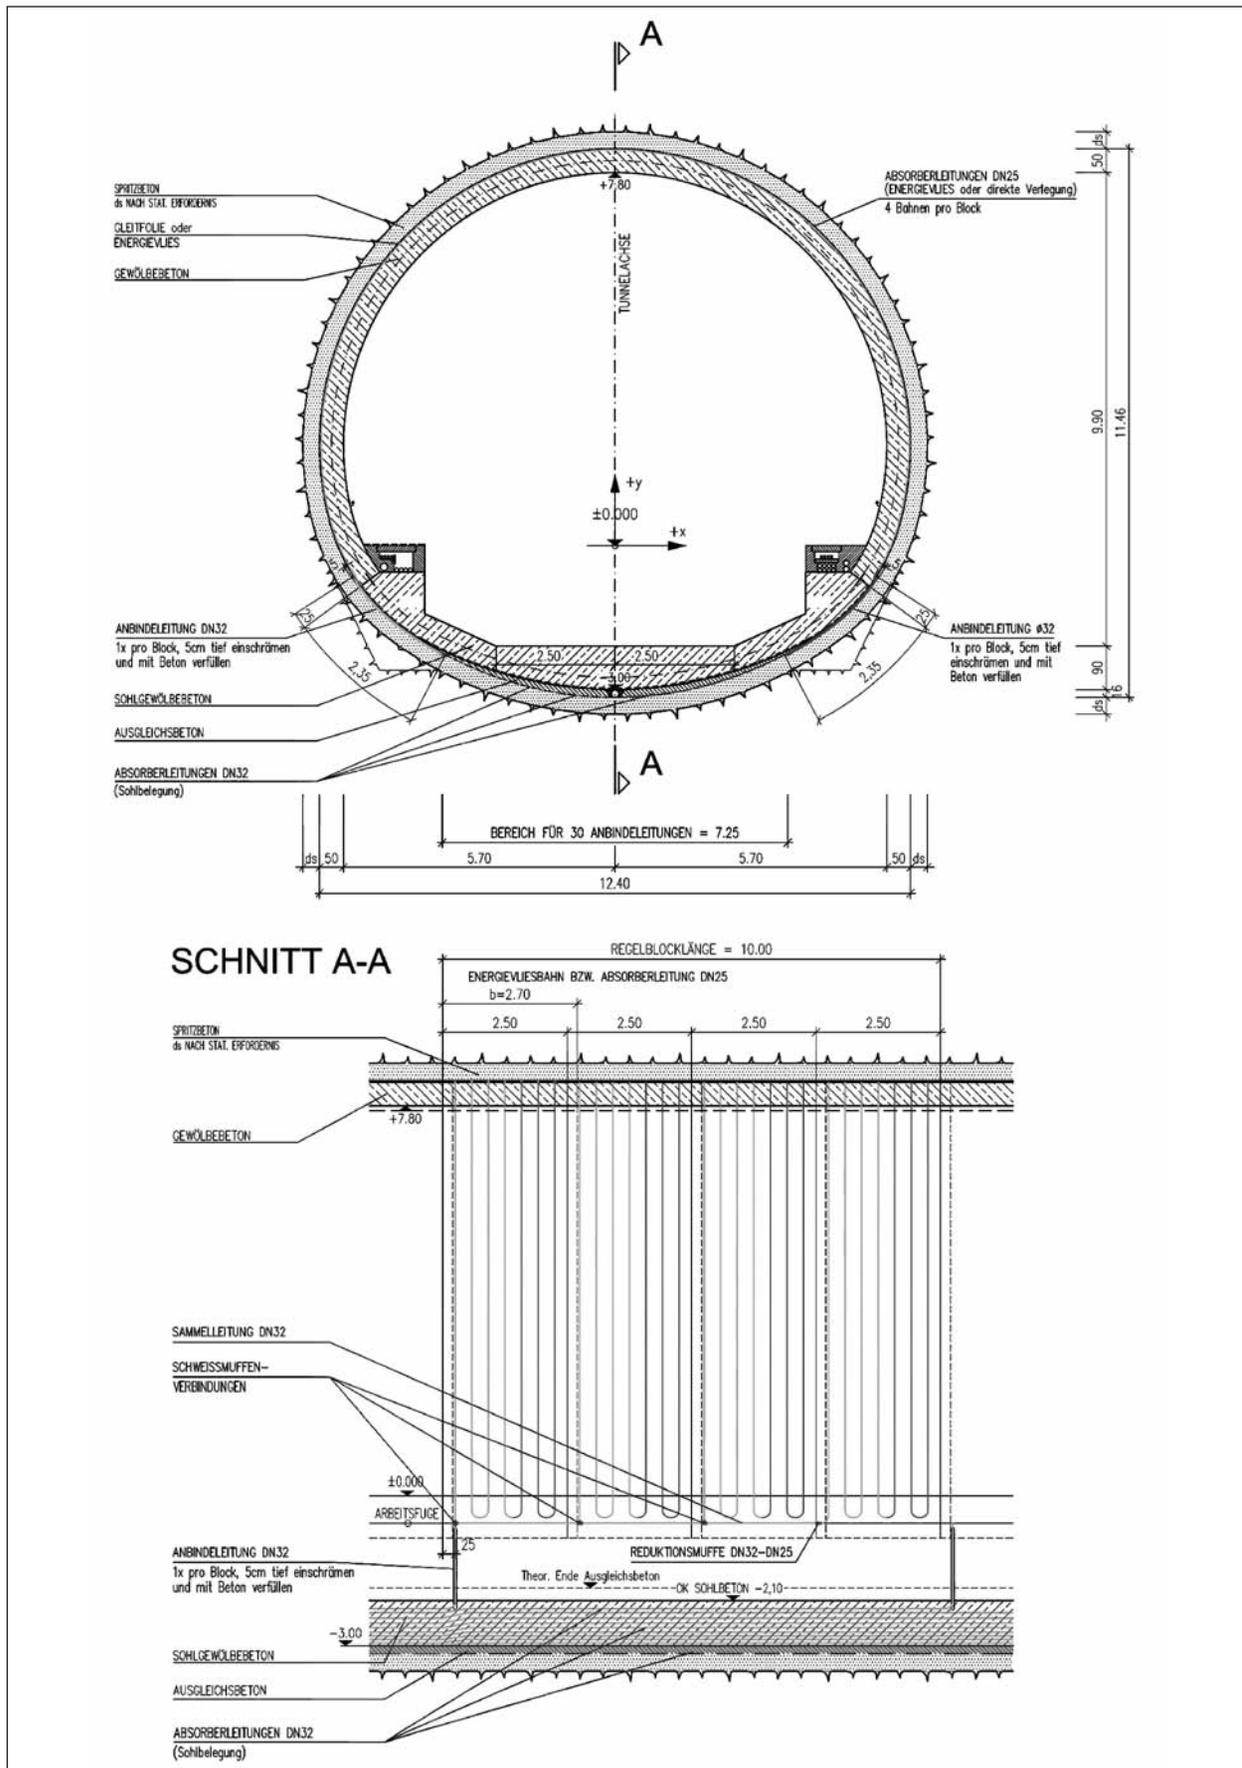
Tunnelröhre in geschlossener Bauweise mit 2-schaliger Konstruktion. Regelquerschnitt und Längsschnitt mit Absorberleitungen (vgl. auch Plan GB-2 im Anhang A)
